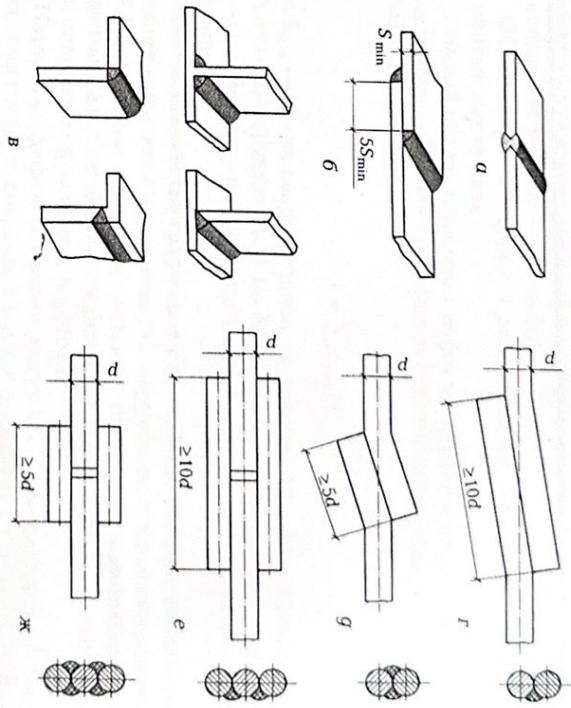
Основные виды сварных соединений и швов:
